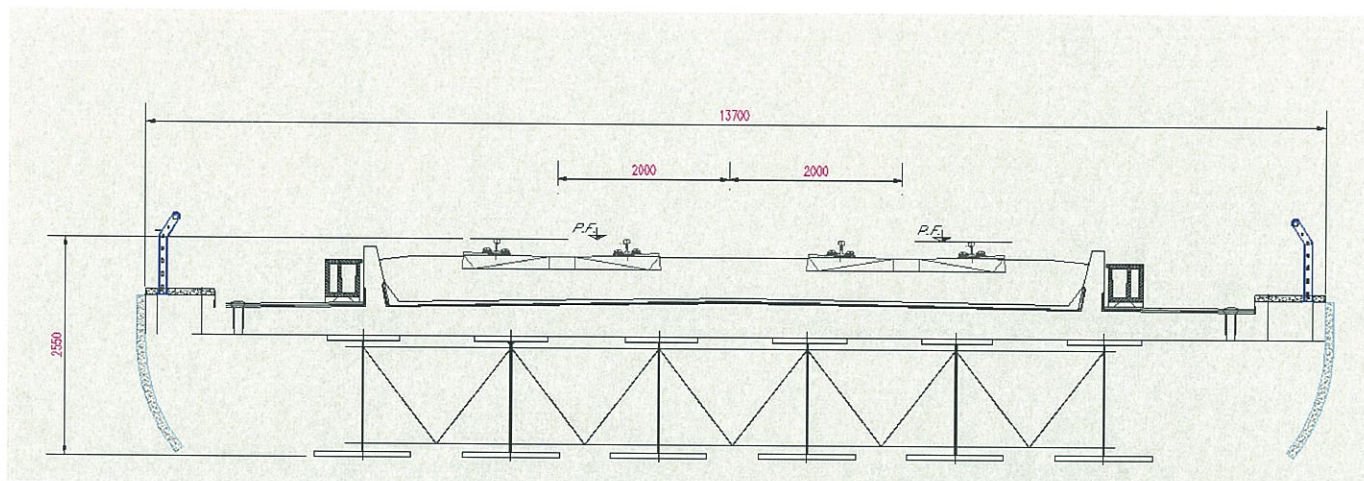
Impalcato in acciaio - cls L = 32 m: sezione trasversale
